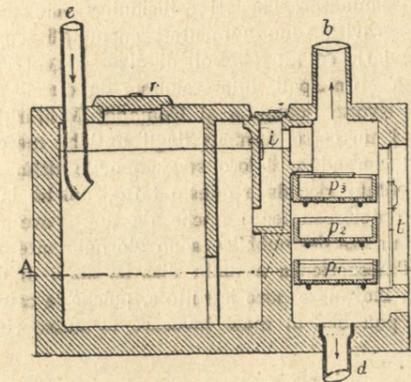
Sezione verticale dell'apparecchio Chopard.
